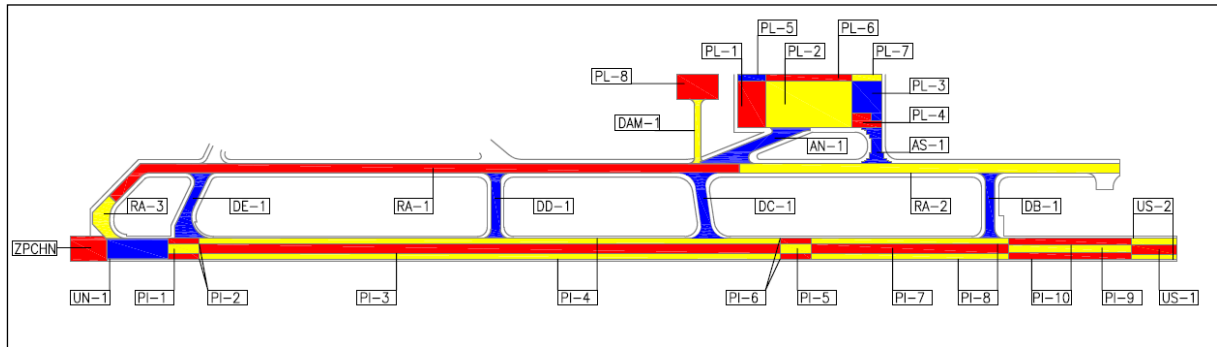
Plano esquemático secciones del aeropuerto Andrés Sabella.
